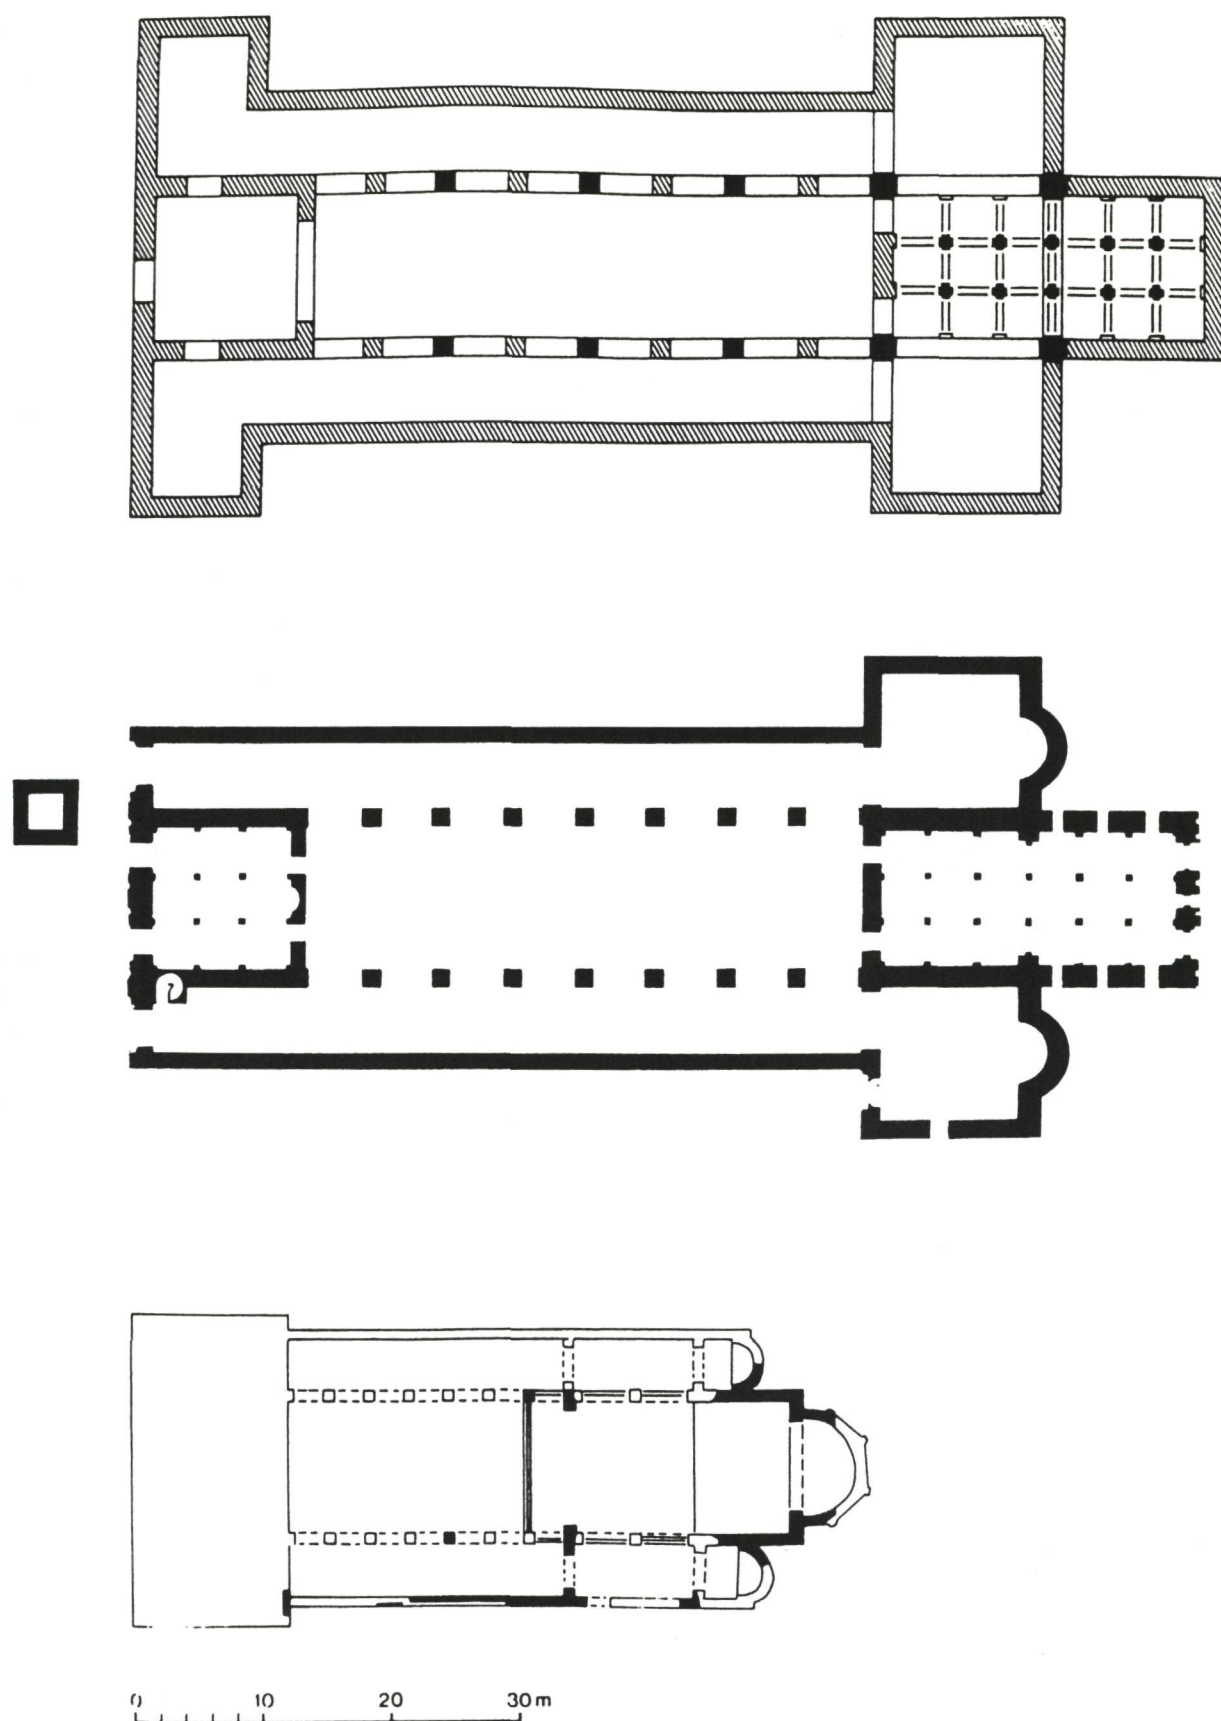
Die rekonstruierten Grundrisse der ältesten Steinkirchenbauten in Hamburg, Bremen und Verden (nach Plagemann 1995 und Boeck 1968), 11. Jahrhundert.
